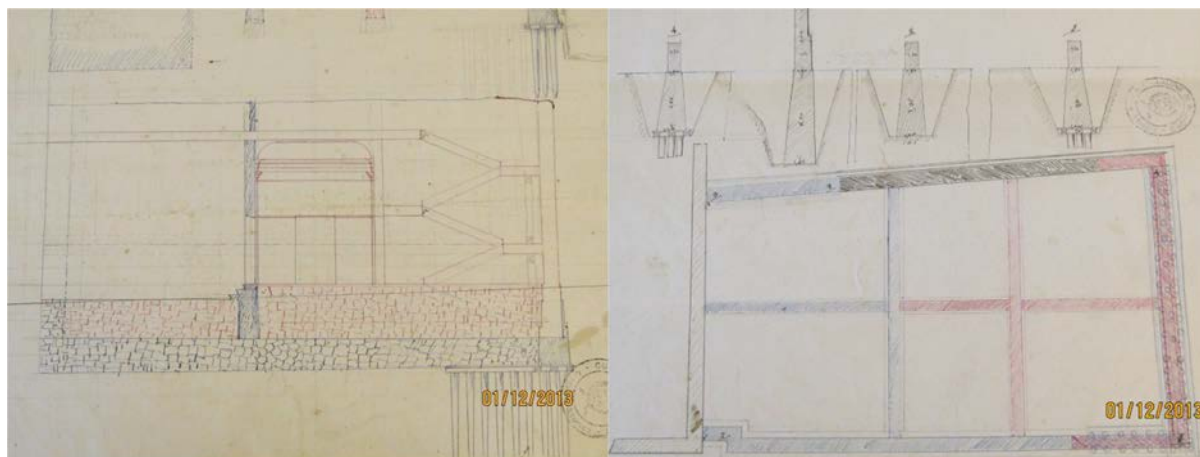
Pianta delle fondazioni e sezione, disegno di progetto di Segusini, 1834, (ASCB). In rosso sono segnate le nuove edificazioni.
